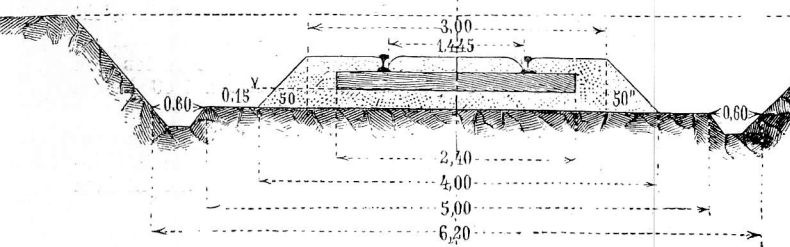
Billige Regelspur II mit eigenen Fahrzeugen. Eingeschränkter Einschnitt in
